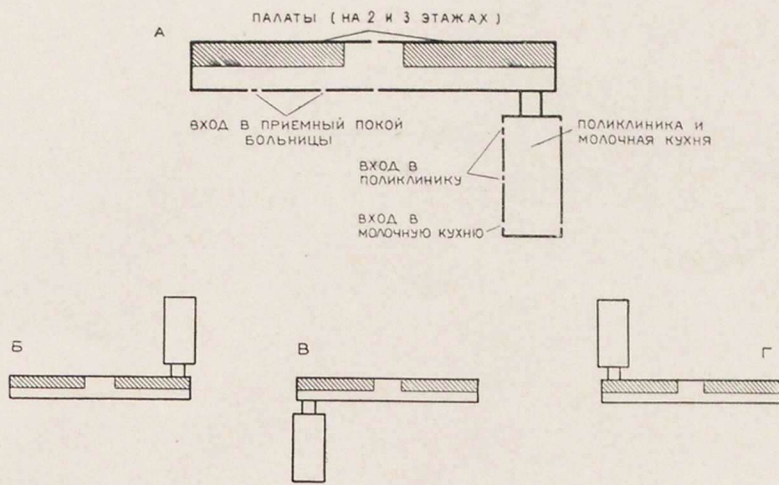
Главный корпус детской соматической больницы на 120 мест
